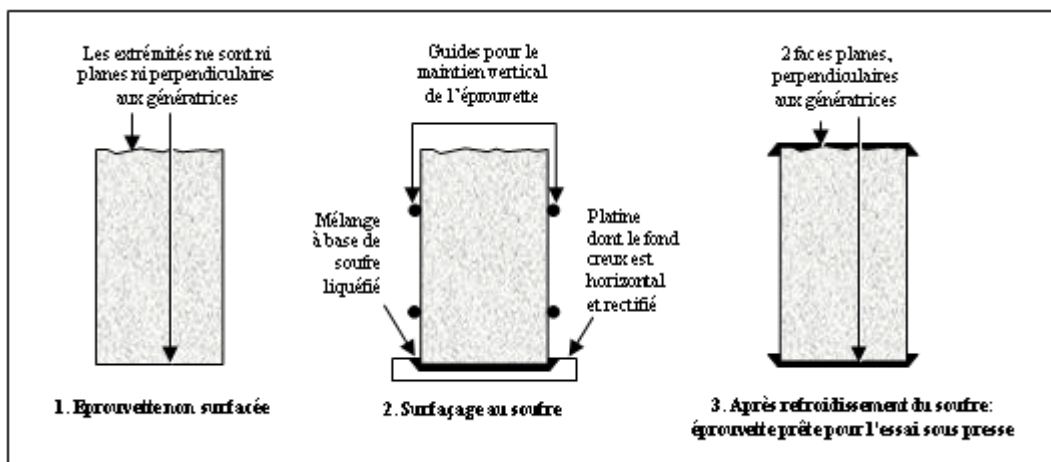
Principe du surfacage des éprouvettes cylindriques à l'aide du soufre
